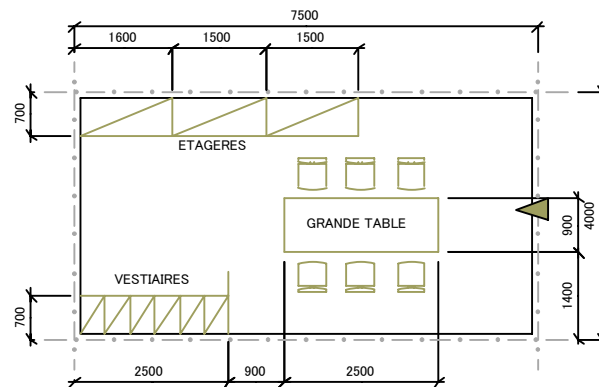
Plan planimétrique du local des collecteurs des frais/agents de nettoyage
